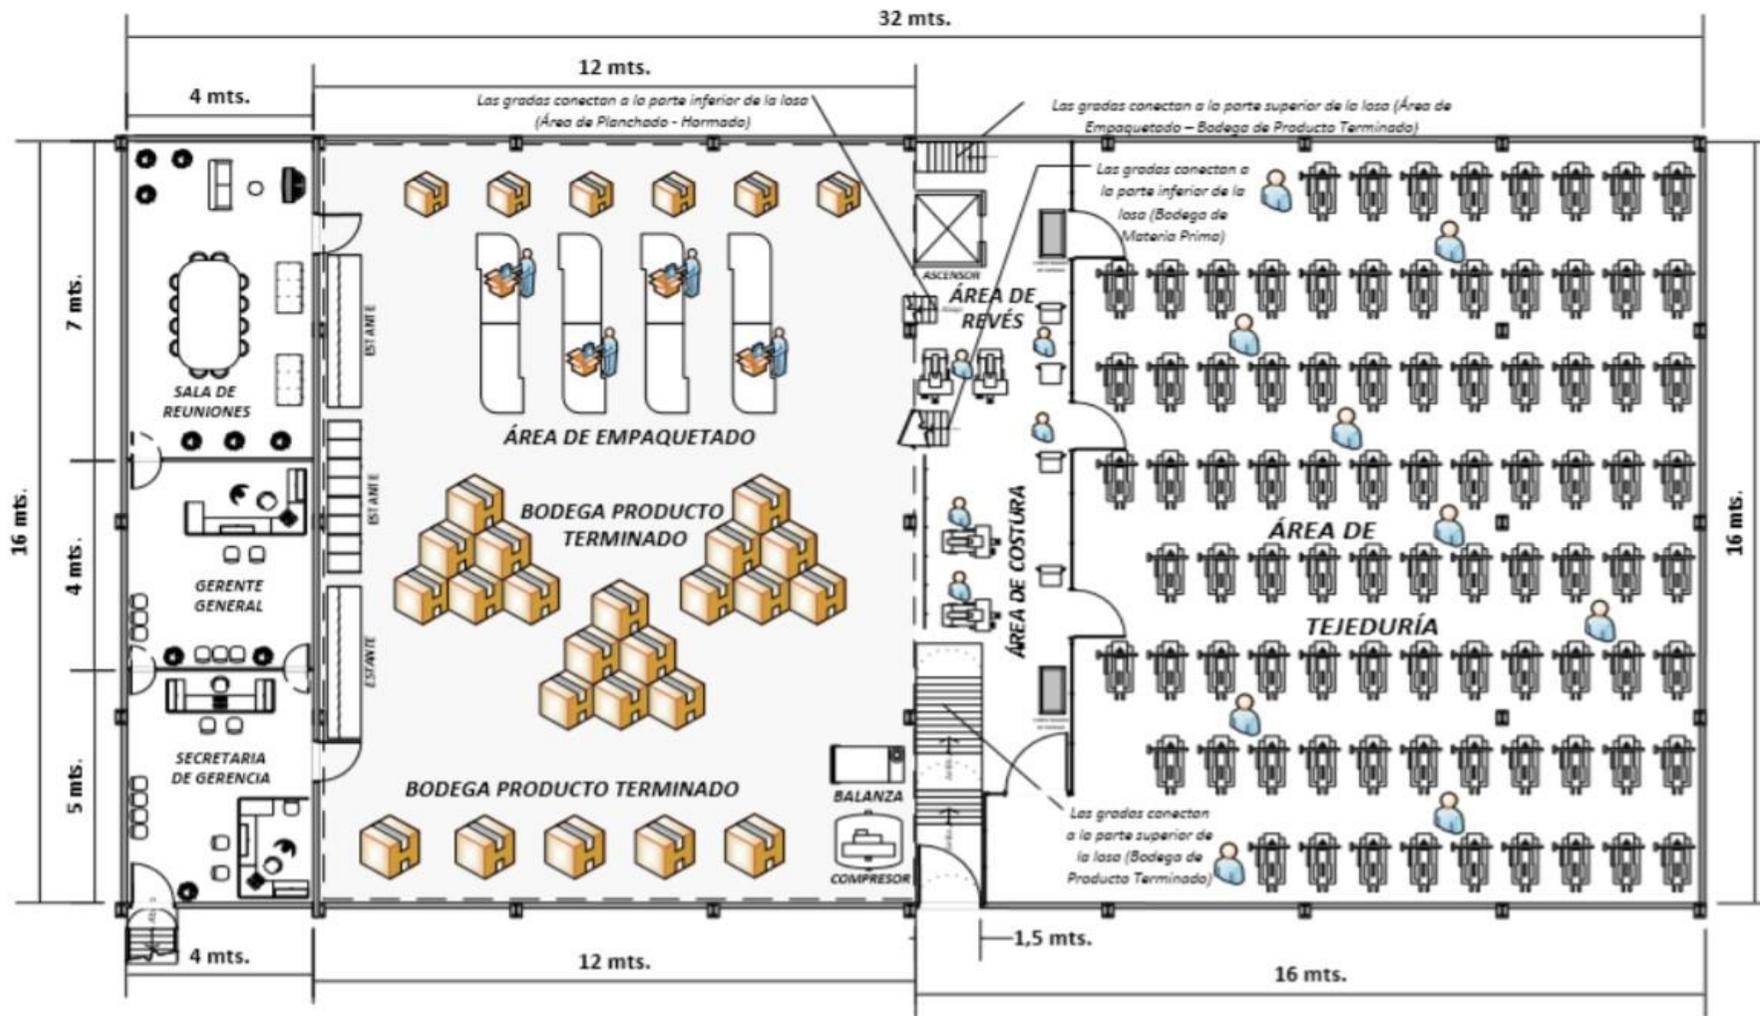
Lay-Out Planta Alta PuntoBaytex.
